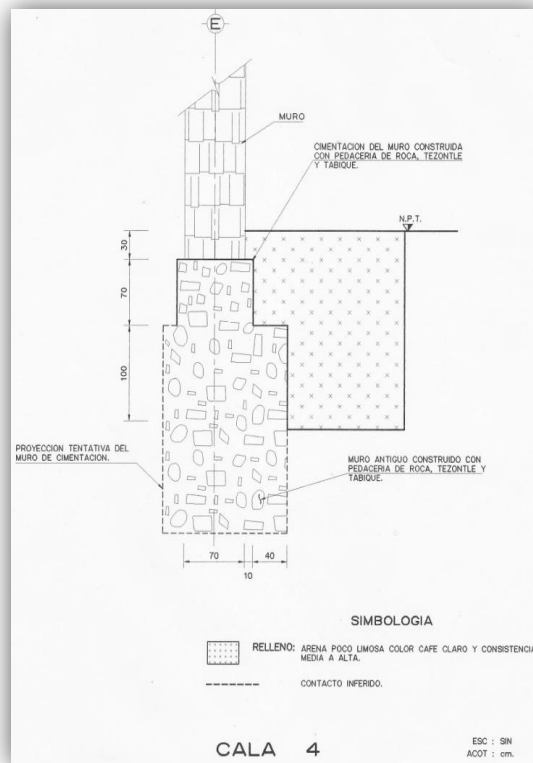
Levantamiento de la cimentación en la calca 4 [2.16].
